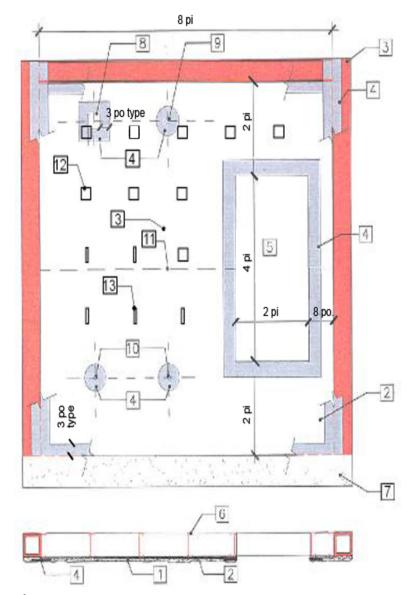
Échantillon nº 4 : Mur opaque avec pénétrations et dispositifs de fixation – Exemple de maintien de la continuité aux joints, aux pénétrations et au mur de fondation – Type de construction : Mur à poteaux métalliques nº 20 avec remplissage et plaques de plâtre pour usage extérieur
